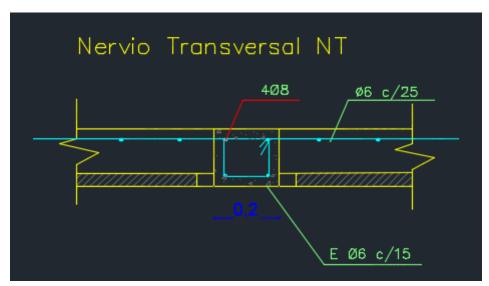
Detalle de nervio transversal incluido en las losas de viguetas
